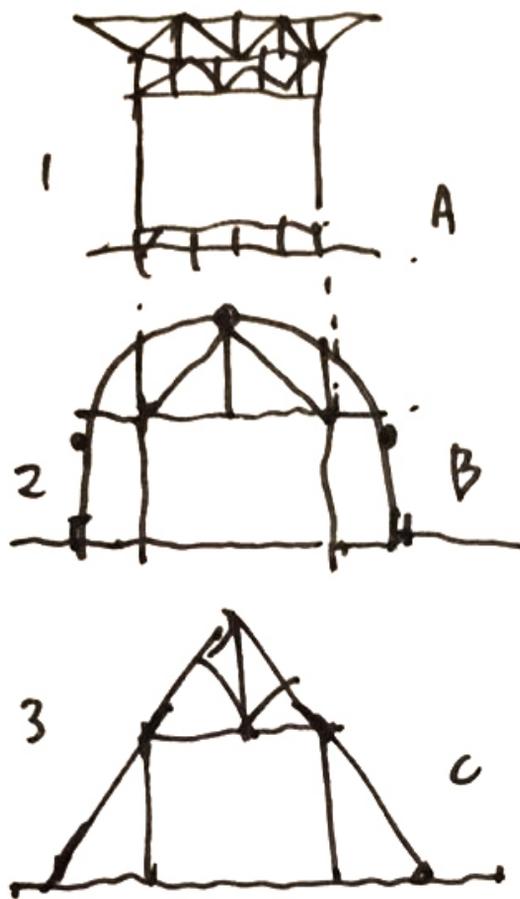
Elaboración propia. (2016). Esquemas conceptuales de las viviendas de emergencia por zona geográfica. Norte arriba, centro al medio y sur abajo.
